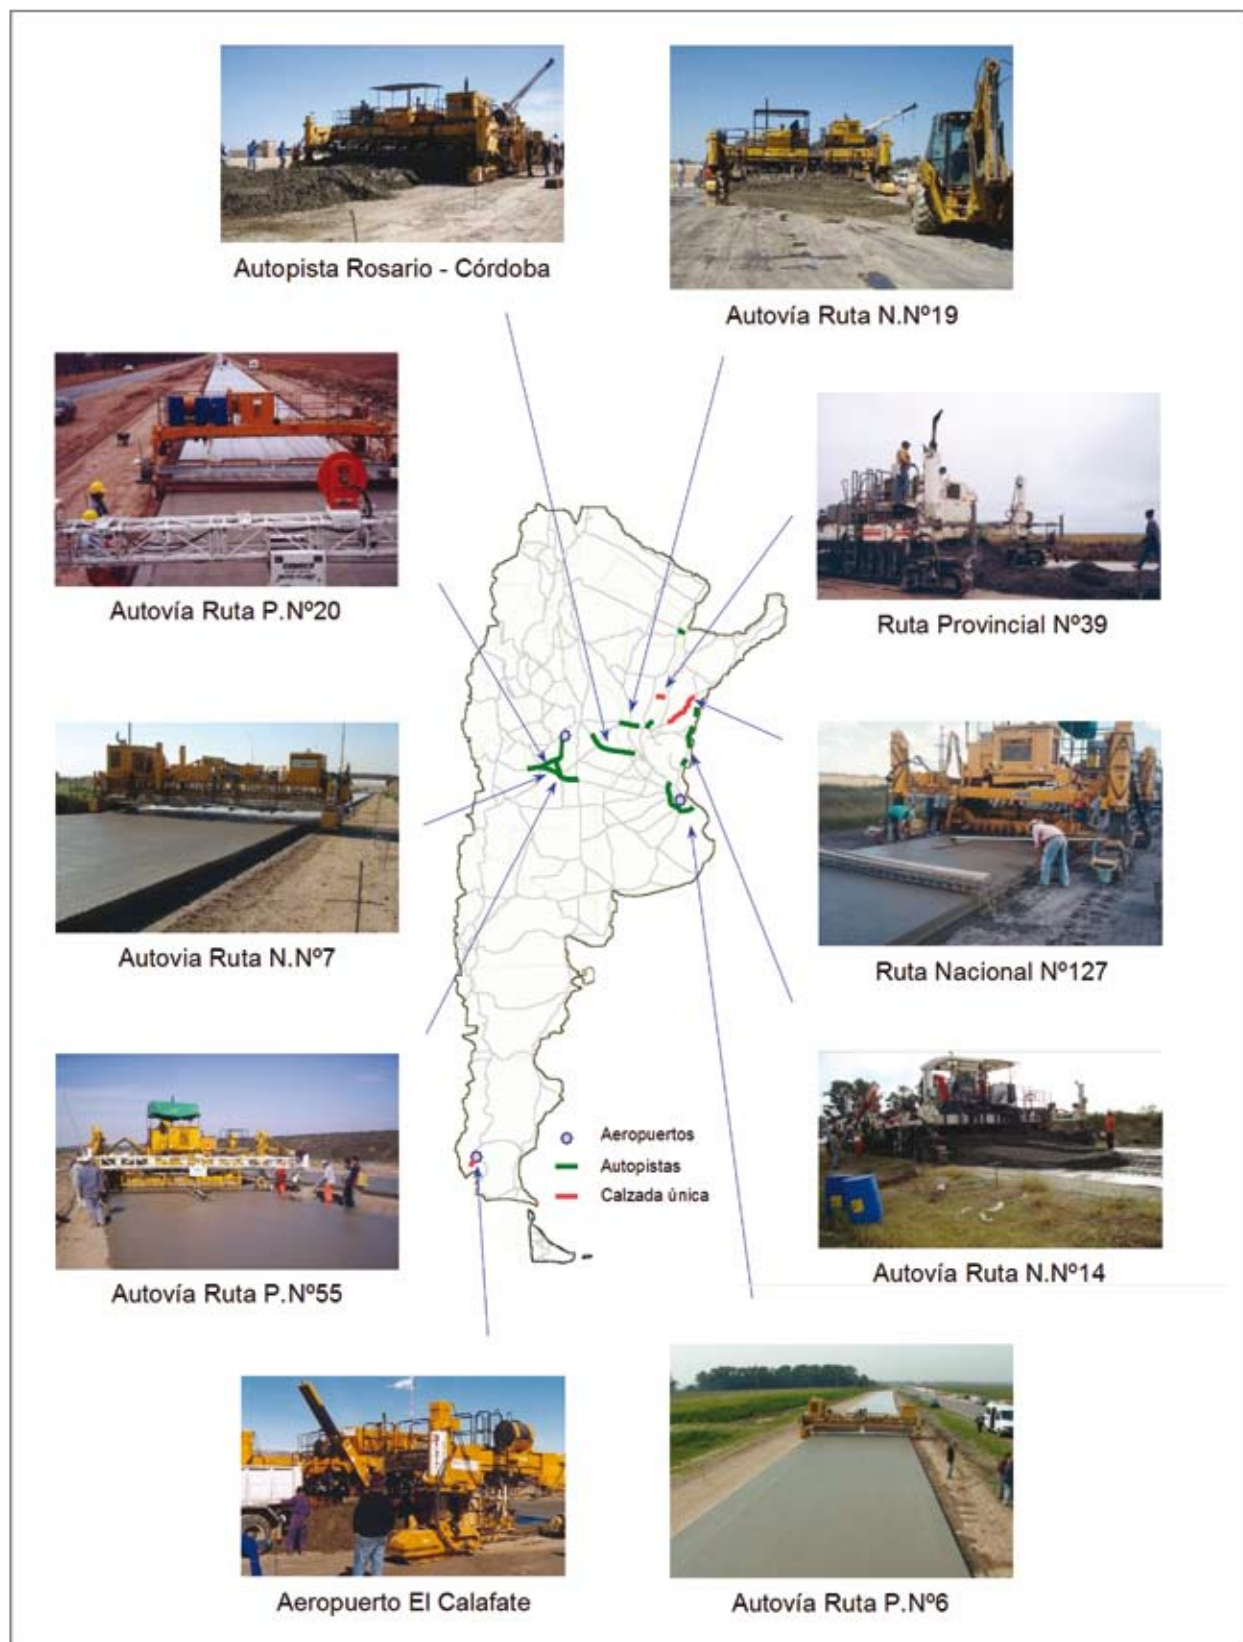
Aplicación las nuevas tecnologías de pavimentación en hormigón en Argentina
